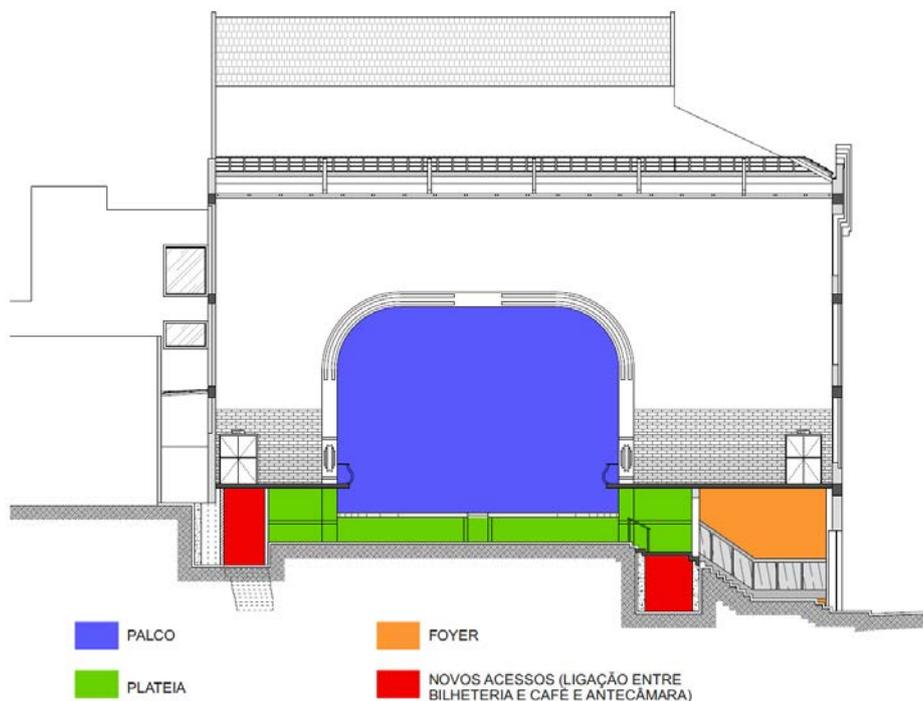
Projeto de restauração e requalificação. Secção longitudinal com setorização.
